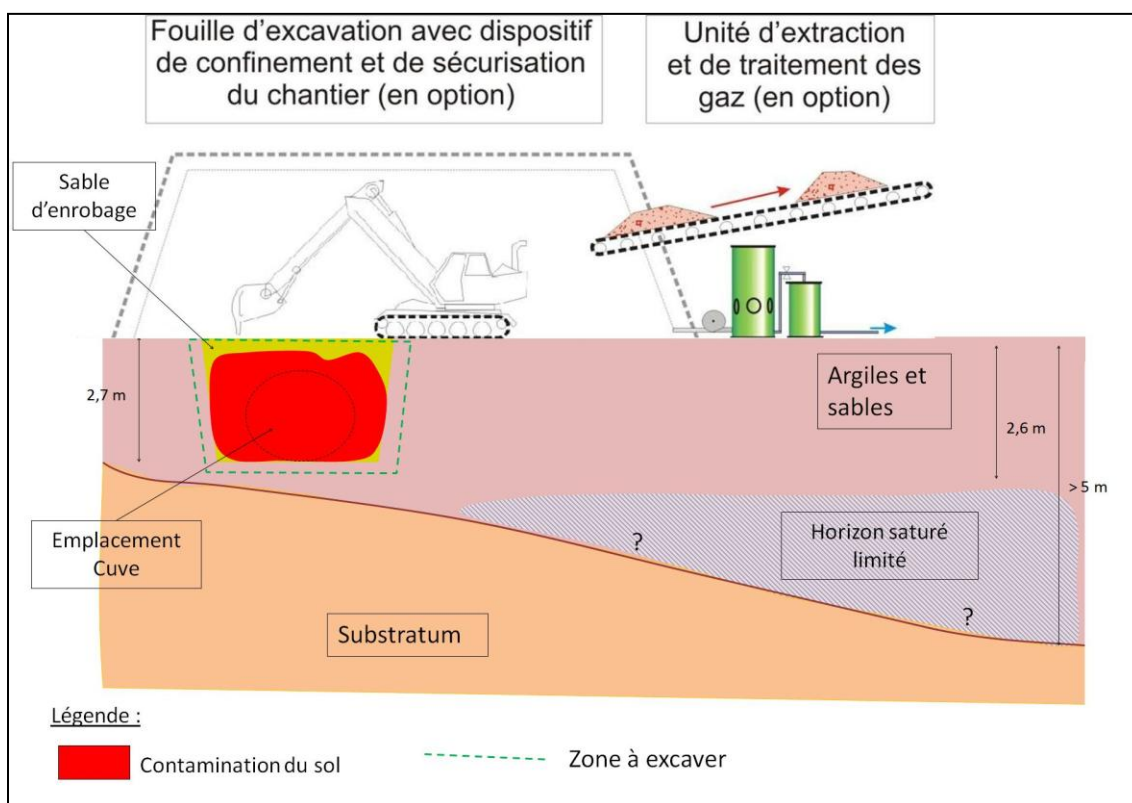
Principe de l'excavation sur le site de Schoelcher
